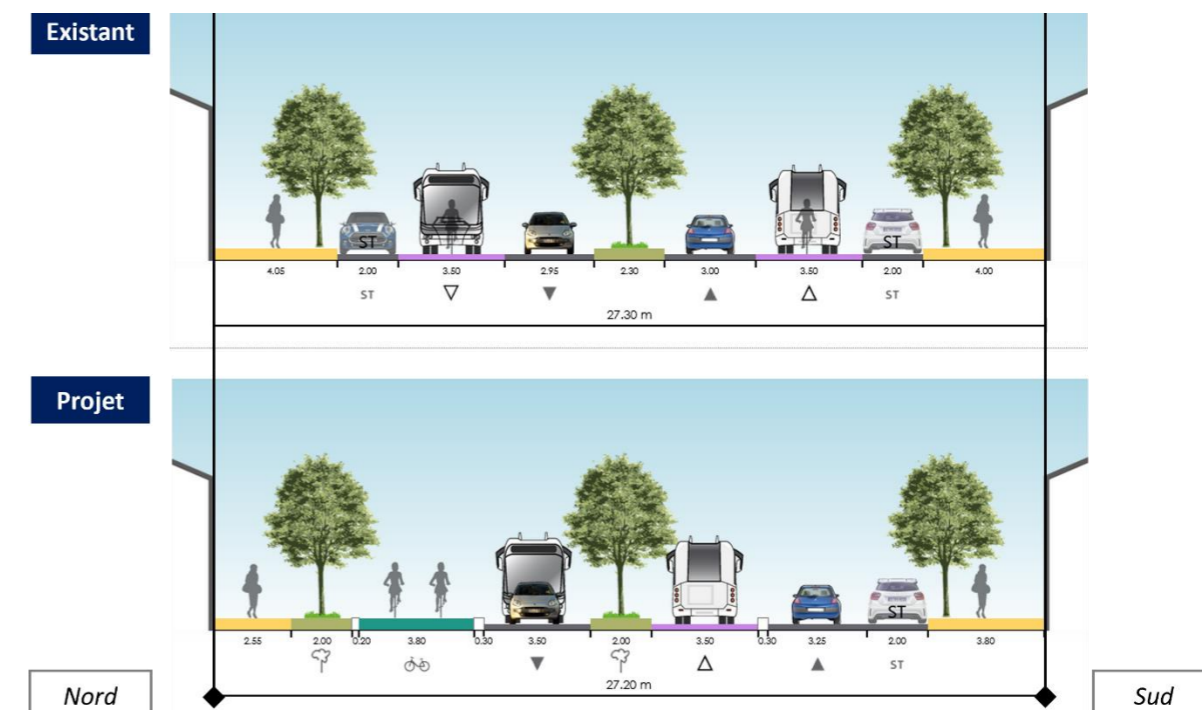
Séquence 2.2 - Boulevard d'Alsace-Lorraine Coupes existant et projet BBM – Coupe n°LP-060 (section courante)
